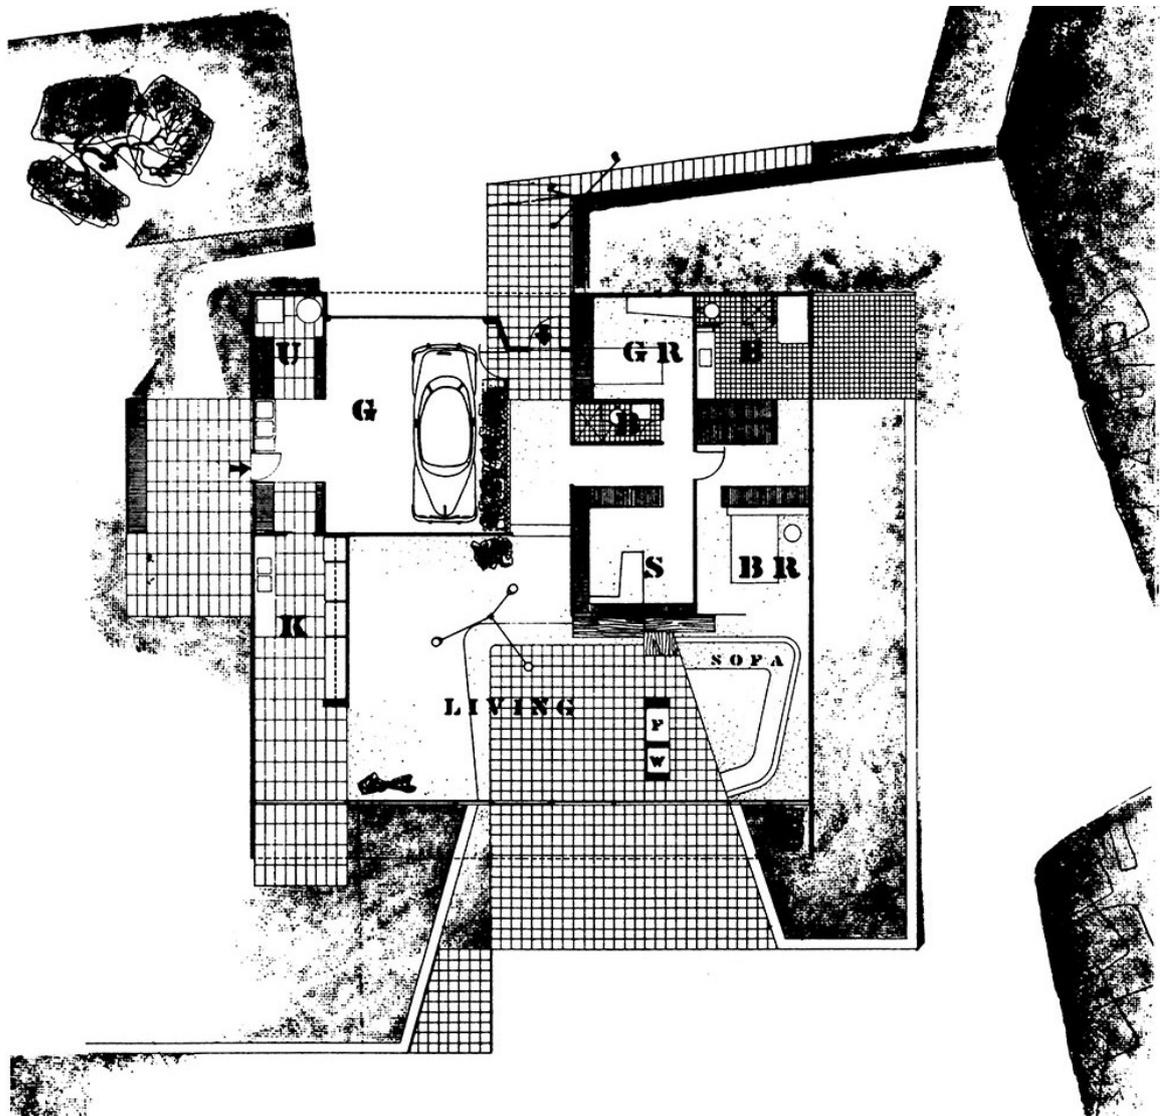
Entenza House, Grundriss, Quelle: [www.archigraphie.eu](http://www.archigraphie.eu)
